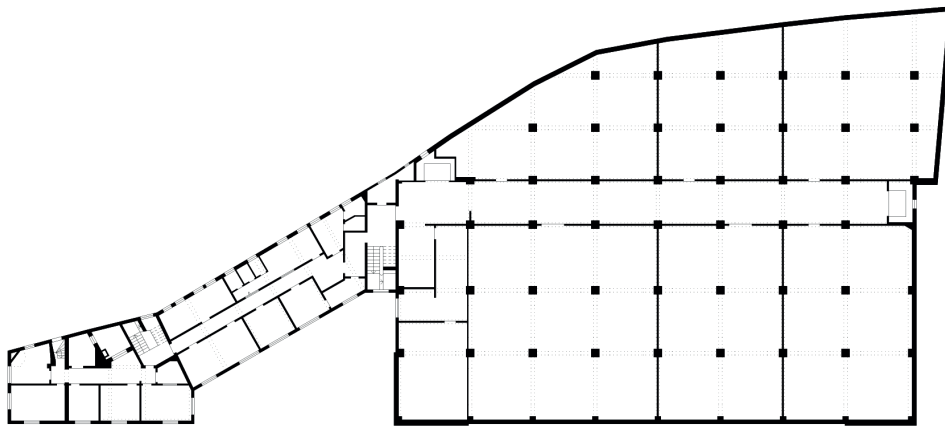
Planta Pisos 1,2 e 3 - Existente.
